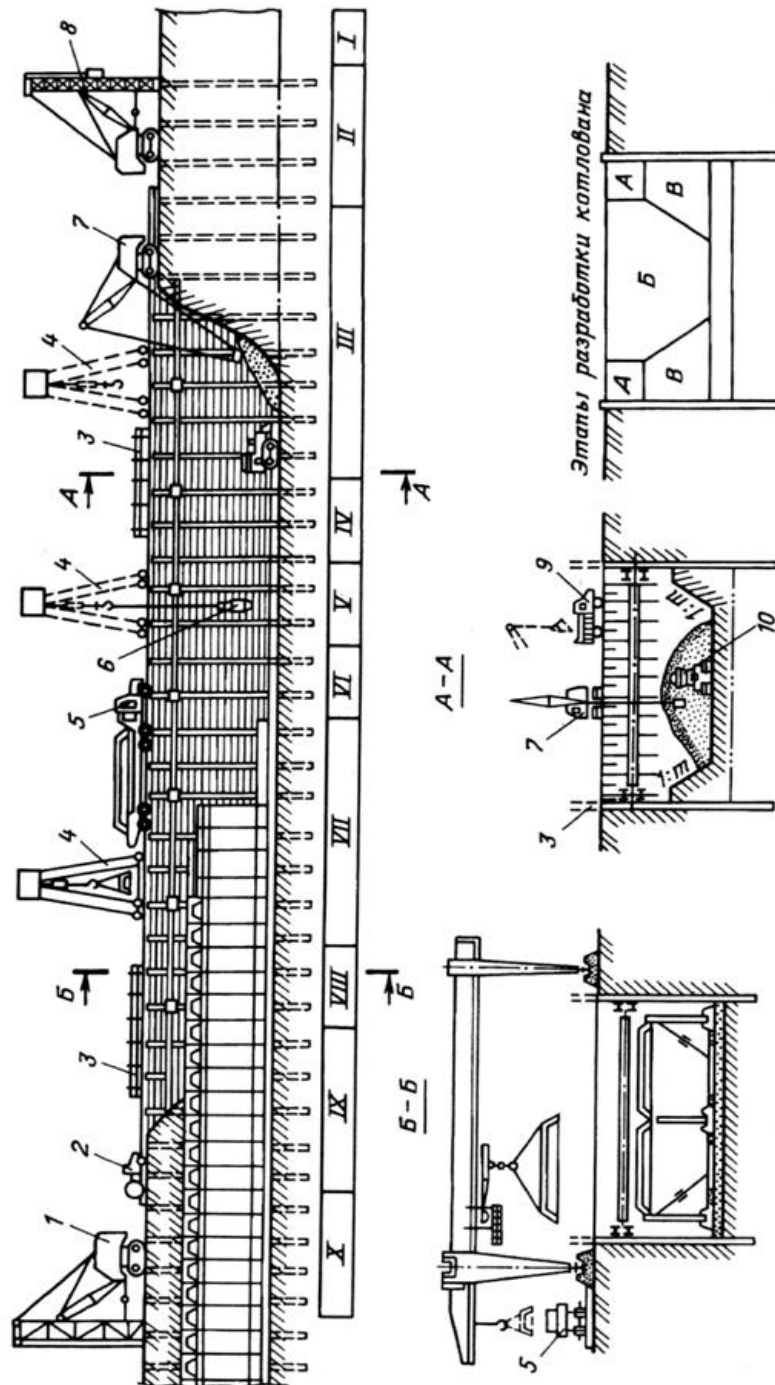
Технологическая схема строительства тоннеля в котловане со свайной крепью: 1 – установка для извлечения свай; 2 – каток; 3 – ограждение котлована; 4 – козловой кран; 5 – трейлер; 6 – бадья для бетона; 7 – экскаватор; 8 – установка для забивки свай; 9 – автосамосвал; 10 – бульдозер
